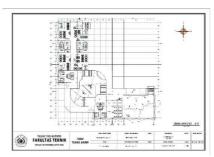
Site Plan (Sumber : Jerri, 2020)
